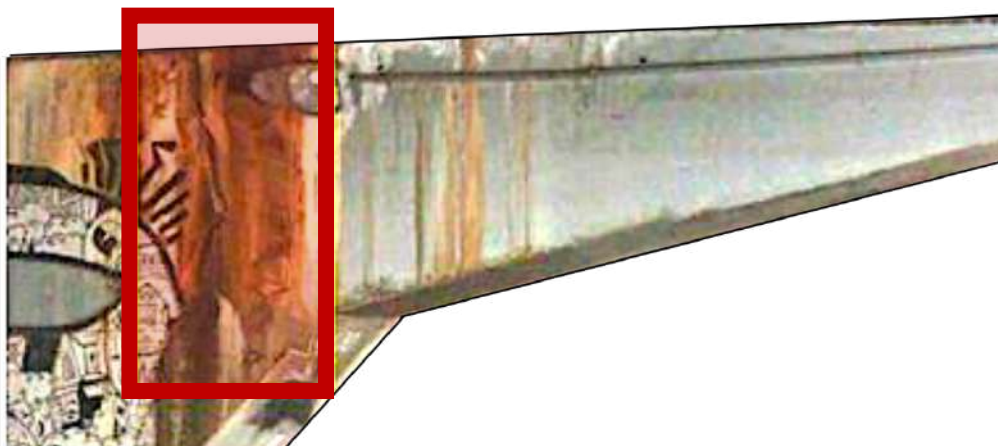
Fissuras ocorridas no pilar P7 antes do colapso estrutural. Fonte: Adaptado de RELATÓRIO TÉCNICO Dept. ENC/UnB 001 (2018)
